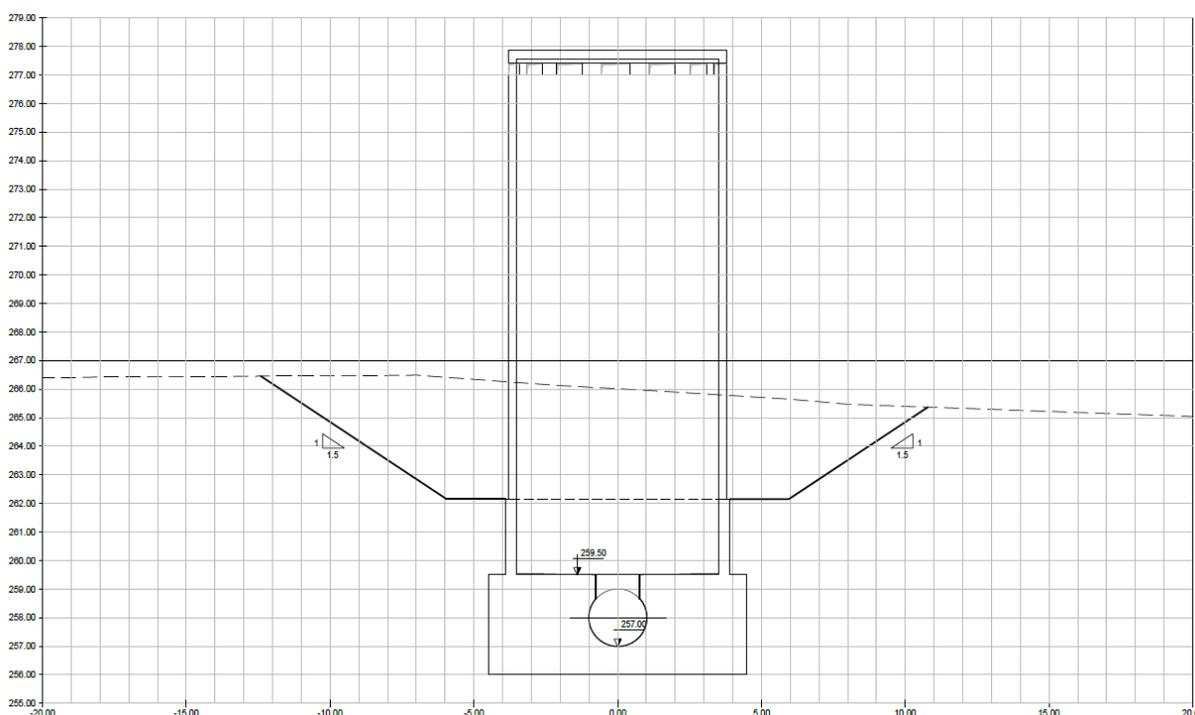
Corte transversal da chaminé de equilíbrio da conduta elevatória.
